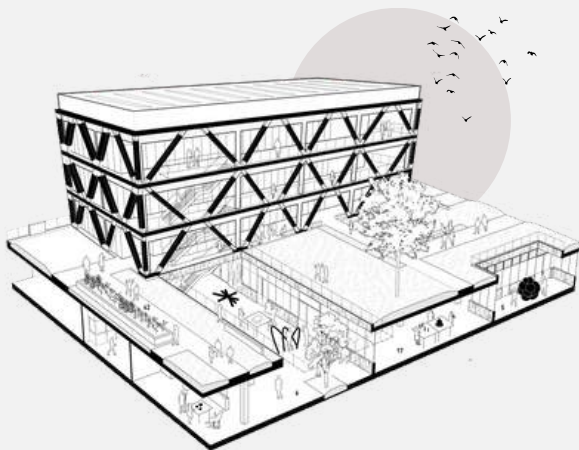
Corte longitudinal. Fonte: Archdaily.
